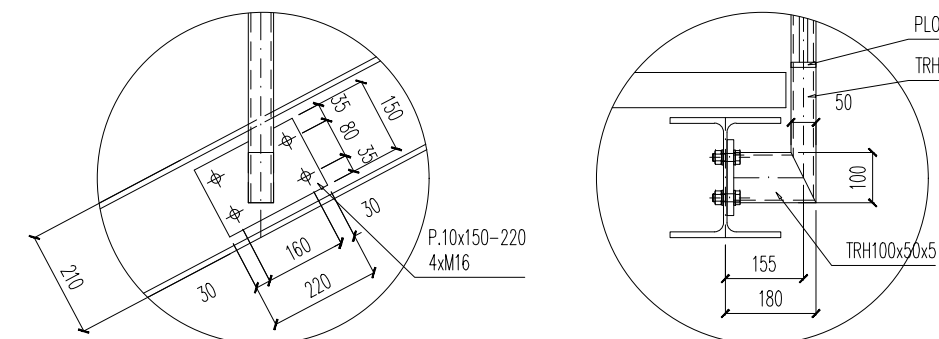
DETAIL KOTVENÍ PŘÍHRADOVÉHO SLOUPU
